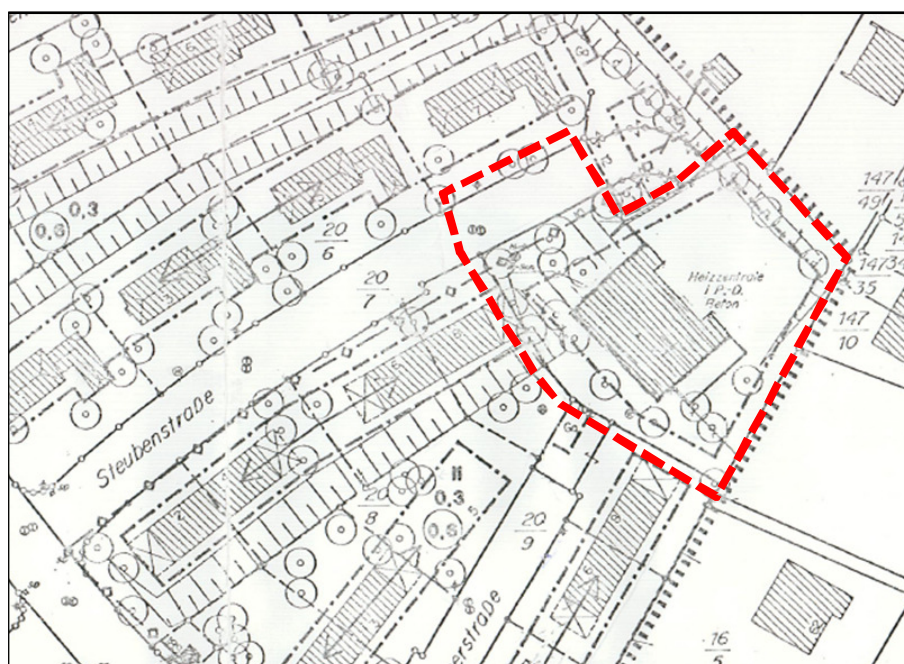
Ausschnitt des wirksamen Bebauungsplan Carl-Schurz-Siedlung“ von 1997 mit Lage des Geltungsbereiches der 1. Änderung (rote Umgrenzung).
